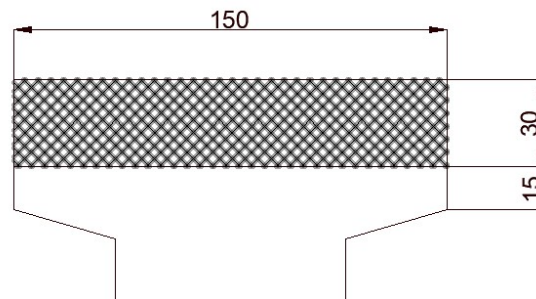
Coupe transversale de la poutre en T et de la dalle.
